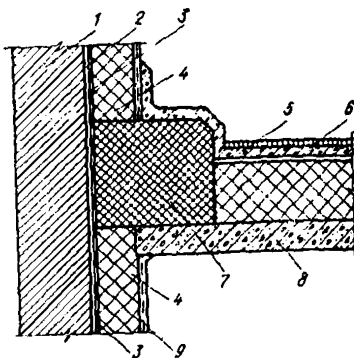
Примыкание междуэтажных перекрытий к наружным стенам
